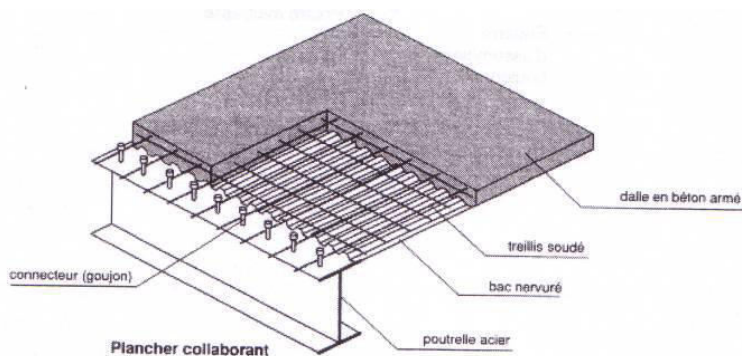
schéma explicatif du plancher collaborant avec des poutres en acier
